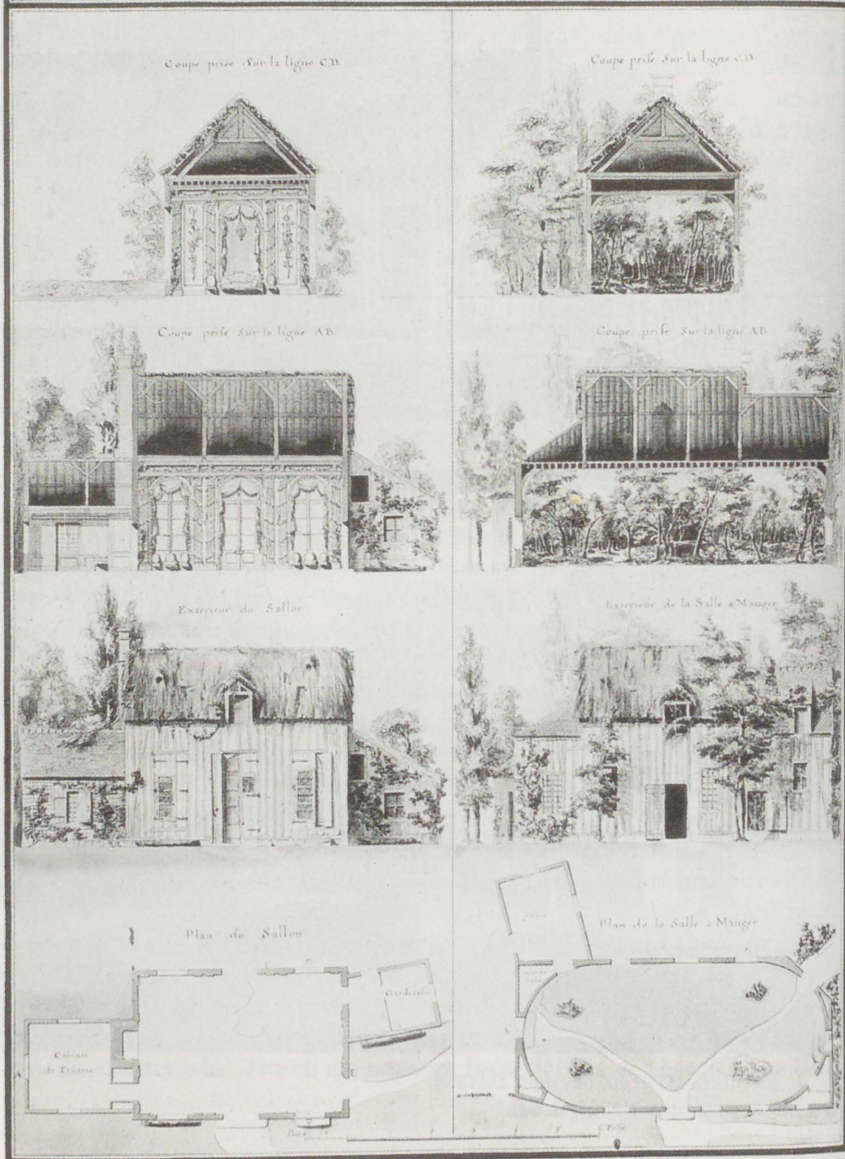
Chantilly, Plans, Elévations et Coupes, du Sallon et de la Salle a Manger du Hameau, Plan aus dem »Recueil des Plans de Chantilly«, 1784. (Aus: Die Gartenkunst 8/1996, S. 61).
